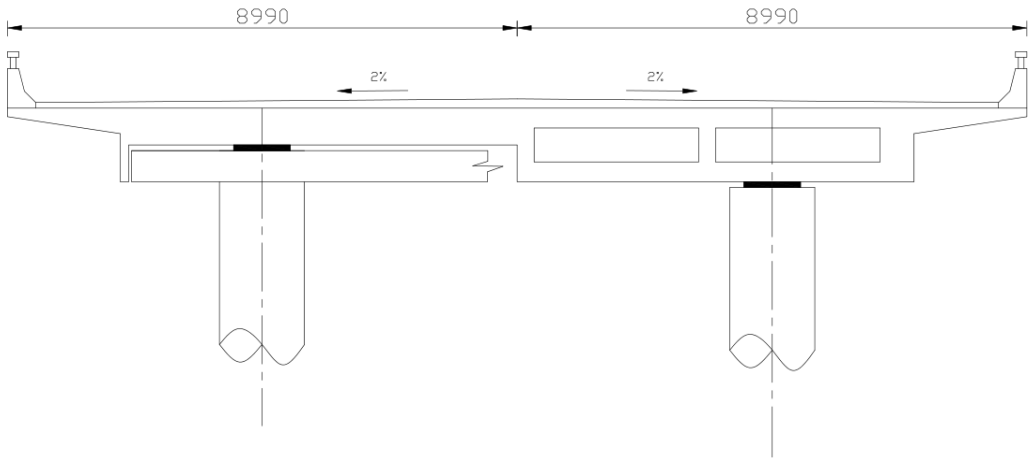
琵琶王立交桥主线桥-梁端截面图（单位：mm）
